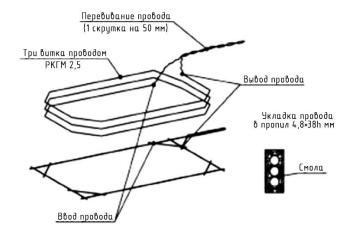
Схема выполнения пропилов в асфальтобетонном покрытии
